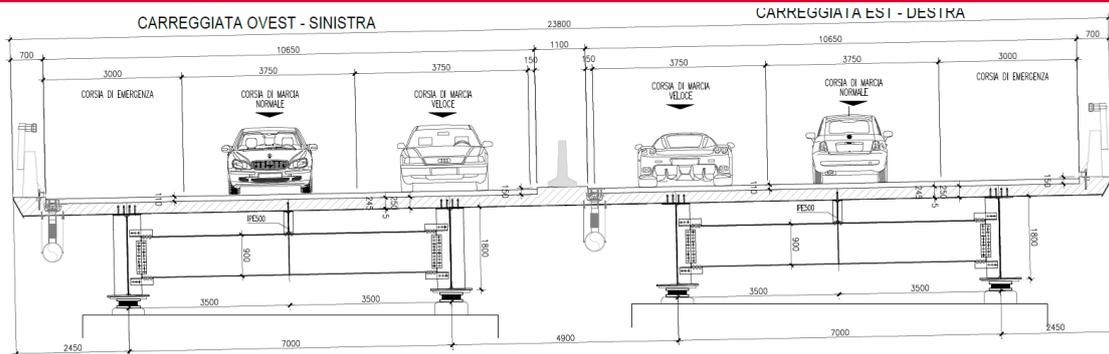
Sezione impalcato viadotto SS17 – Stato futuro
